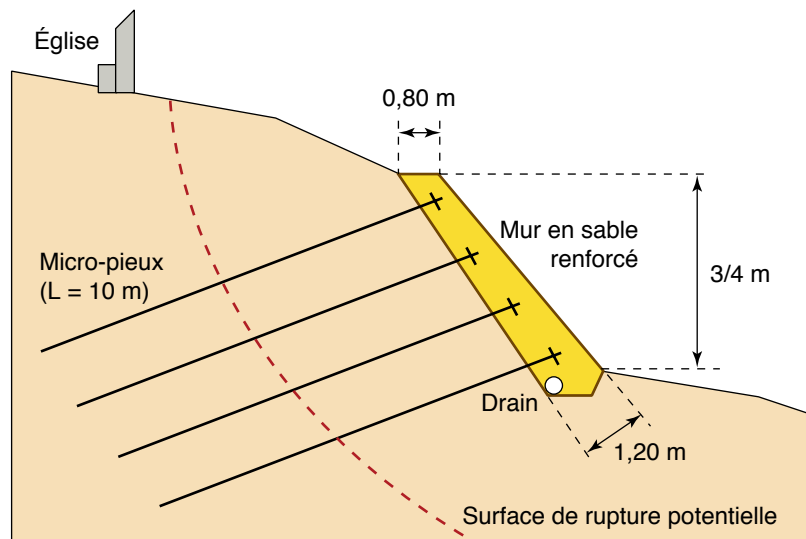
Coupe schématique du clouage de Varengeville-sur-Mer
